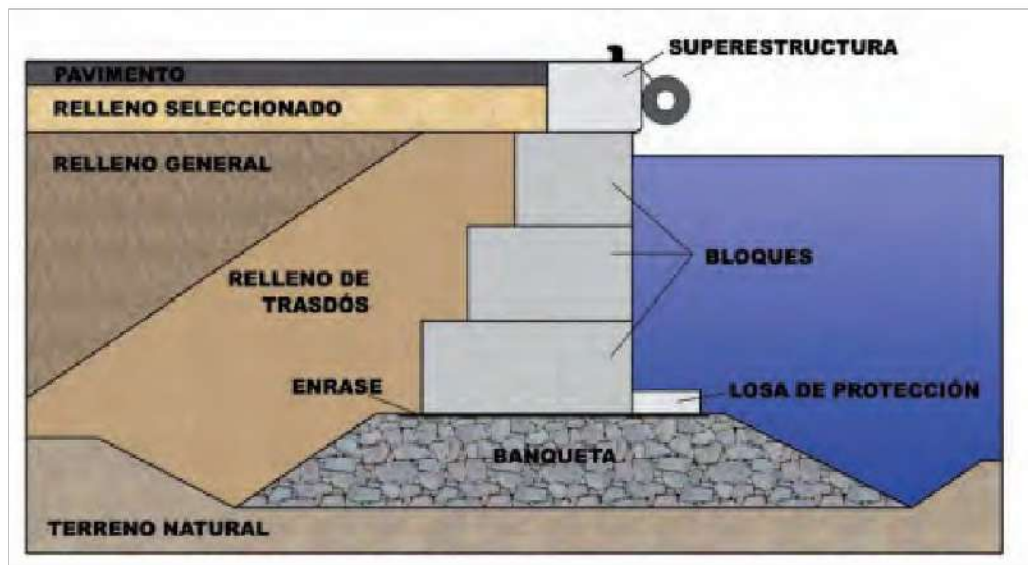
Perfil constructivo de muelle asentado sobre banqueta. Fuente y elaboración: Gobierno de España, 2008.
